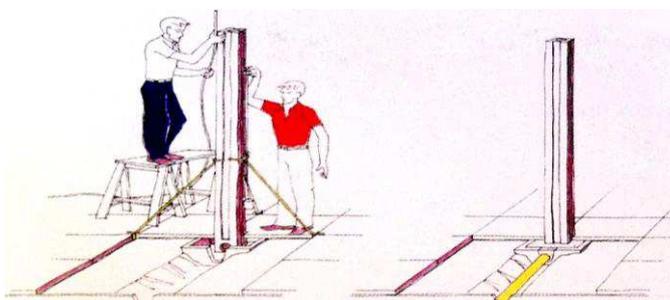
Perspectiva esquemática com montagem de pilar em argamassa armada.
